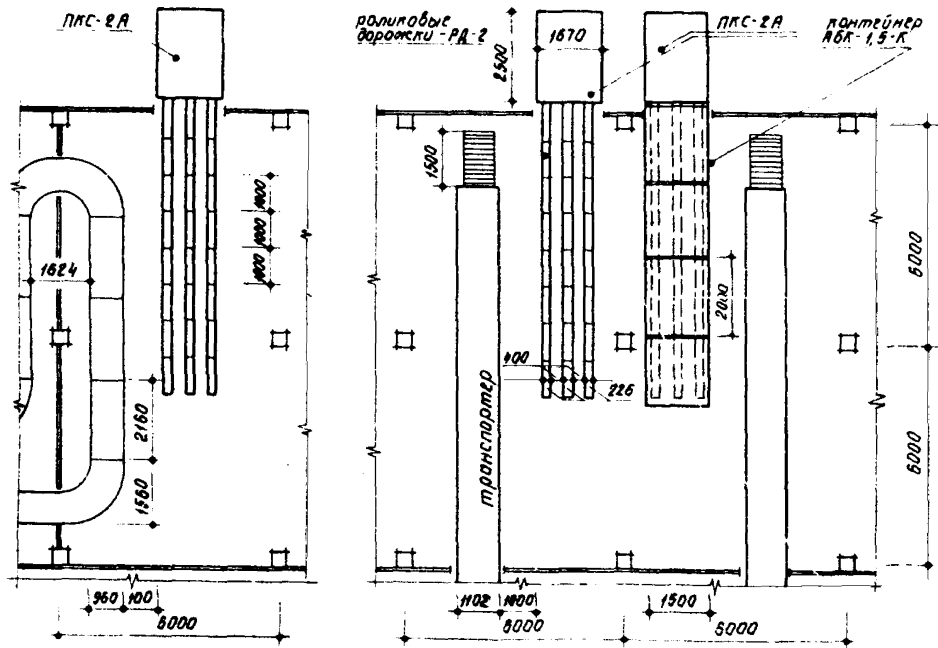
Схема планировки помещений обработки багажа, перевозимого самолетом Ил-86, в зоне вылета и прилета аэровокзала (один технологический уровень)
